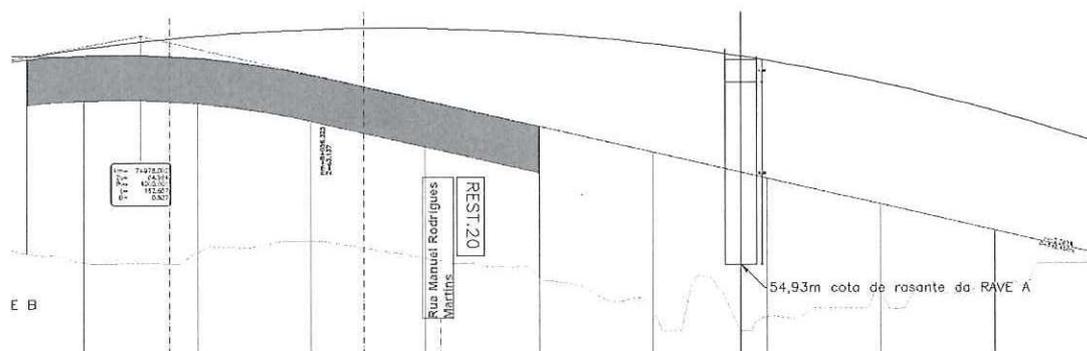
SOLUÇÃO A DO TRAÇADO DA RAVE – PERFIL LONGITUDINAL
